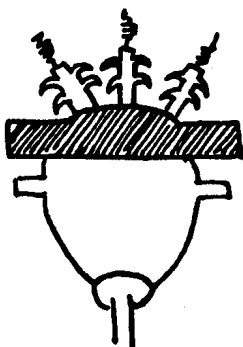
, vista exterior de -- una mufa con sus aisladores y los cables de acometida y un tubo donde sale el cable armado.
